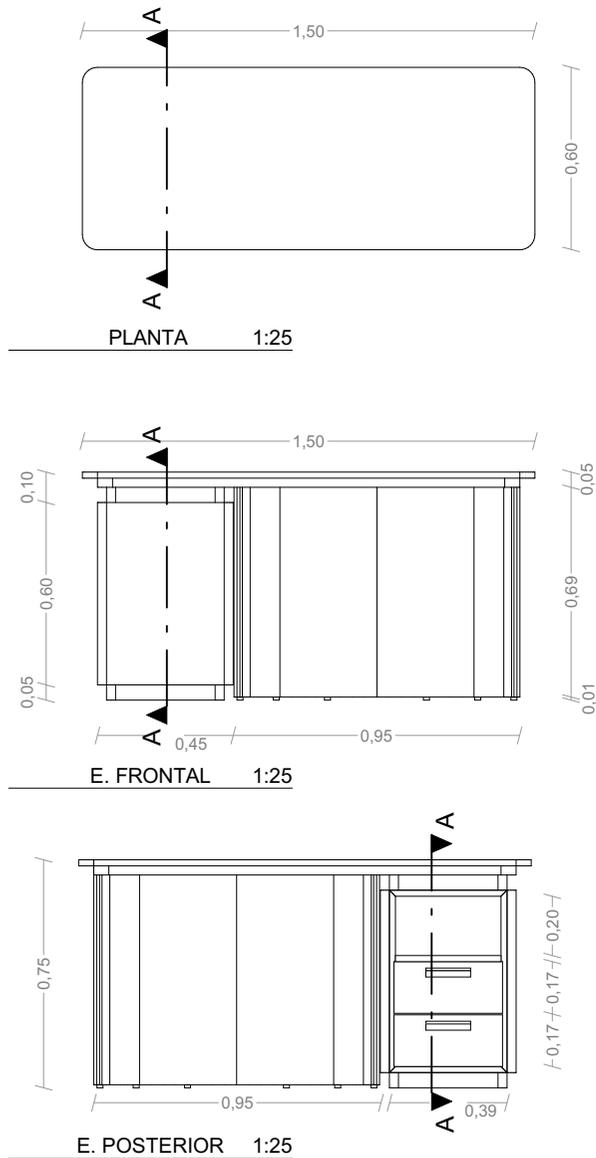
Detalle constructivo counter CEDIUC Fuente: Propia
